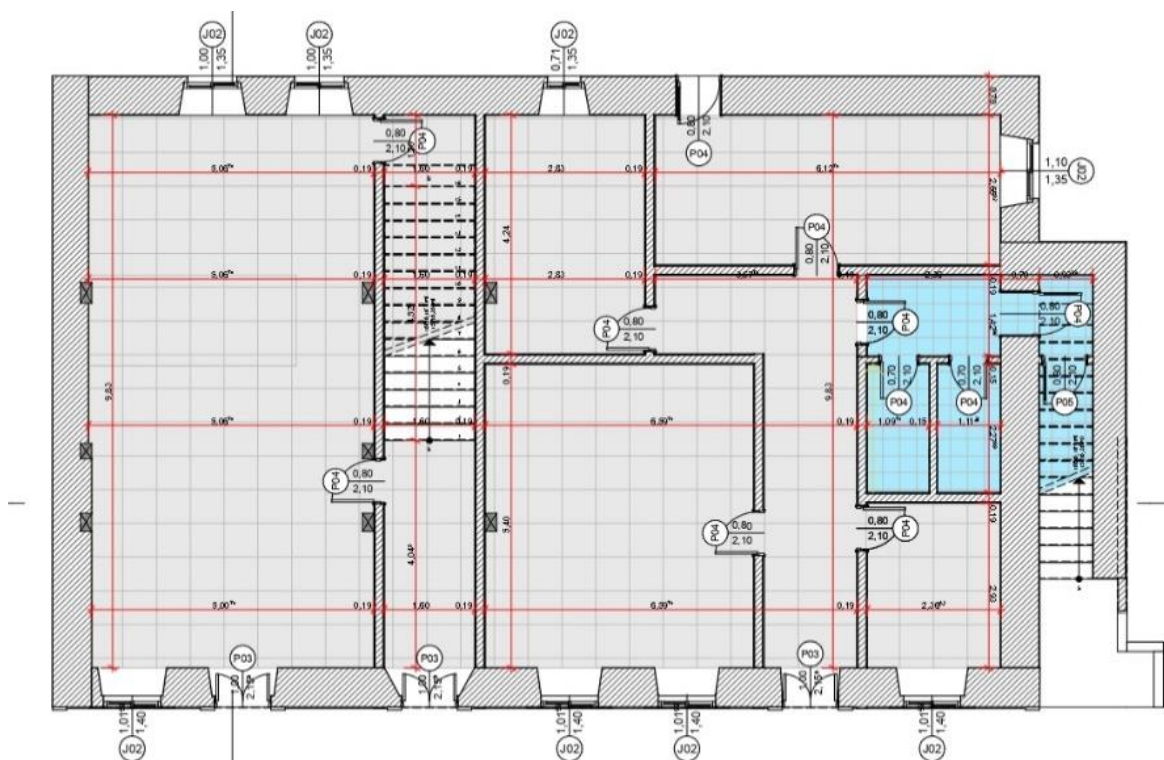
Planta existente do piso térreo. Fonte - acervo do autor (2024)
